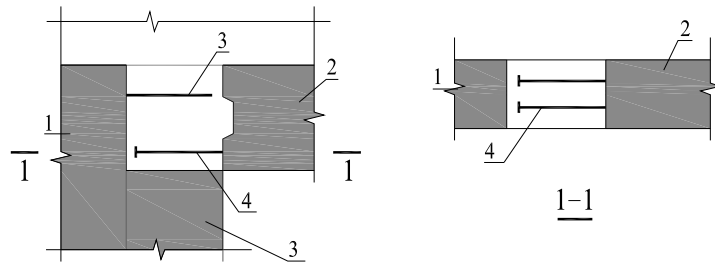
预制连梁钢筋在局部后浇节点区内锚固构造示意
